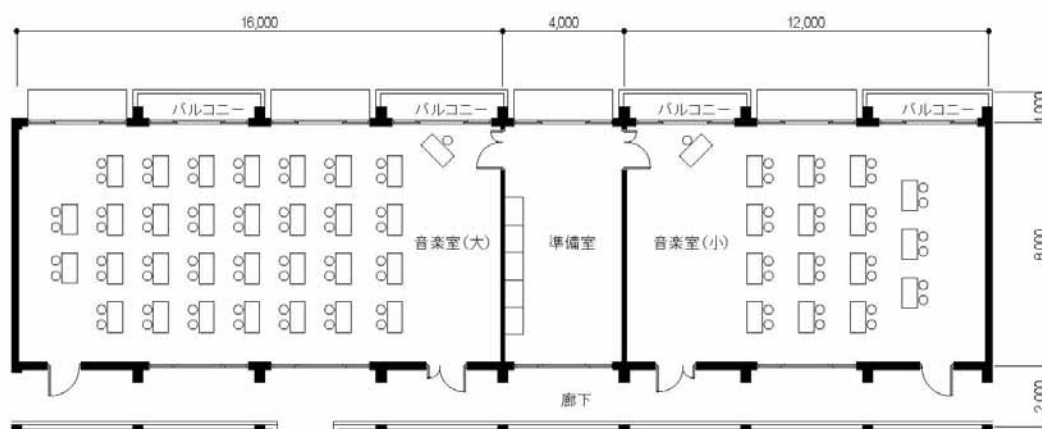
音楽室（大）、音楽室（小）および準備室平面図
